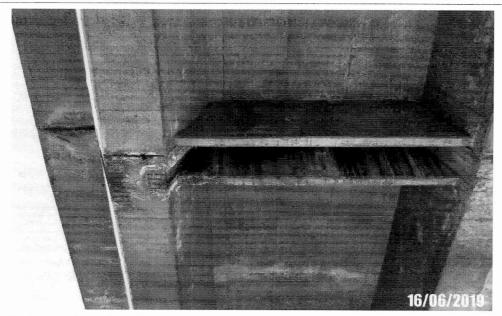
Detalhe da face inferior do tabuleiro com armadura exposta e infiltração, devido a patologia na junta de dilatação.
